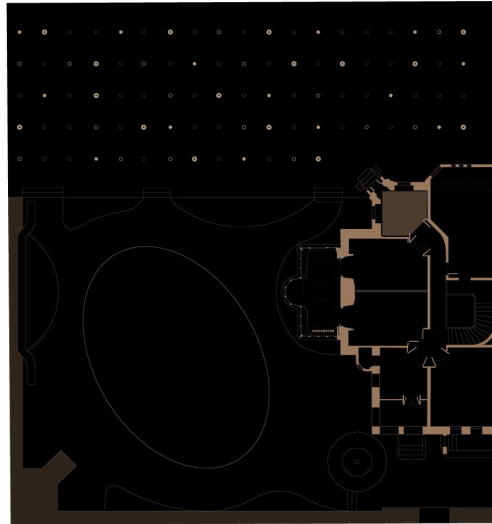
Planta baja de Casa Vicens, Gaudí, 1885. Planimetría inédita de elaboración propia a partir de los archivos originales del proyecto. Sombreado sólido de posición del fumadero en la vivienda, 2023.
